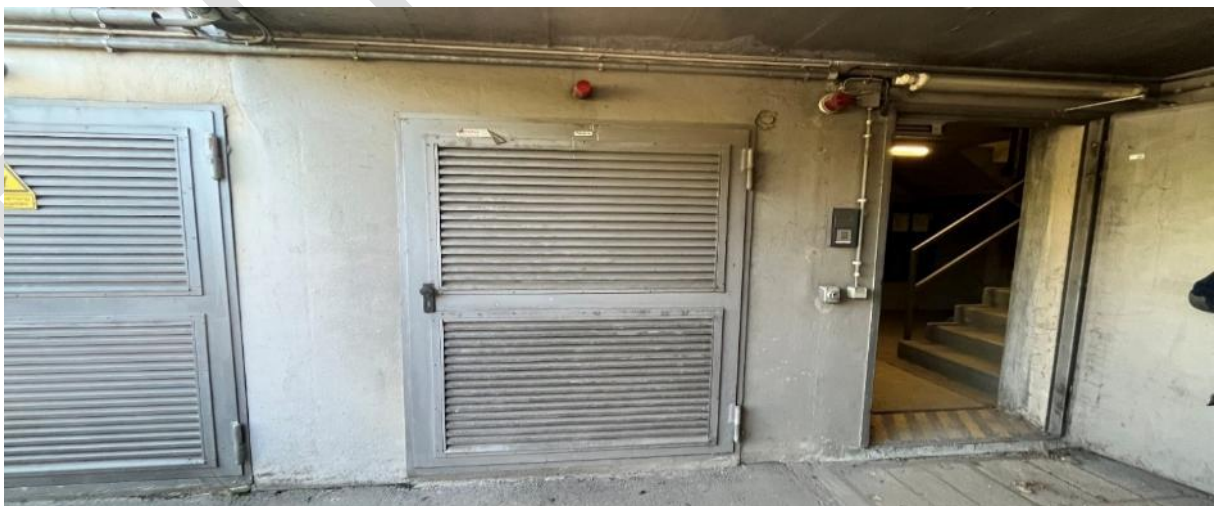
Eingang Betriebsgebäude vom Trafobereich
